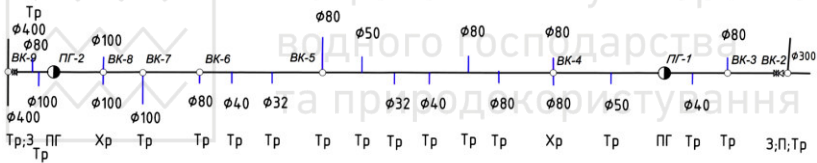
Схема розташування трубопровідної арматури та фасонних частин на ділянці водопровідної мережі:
